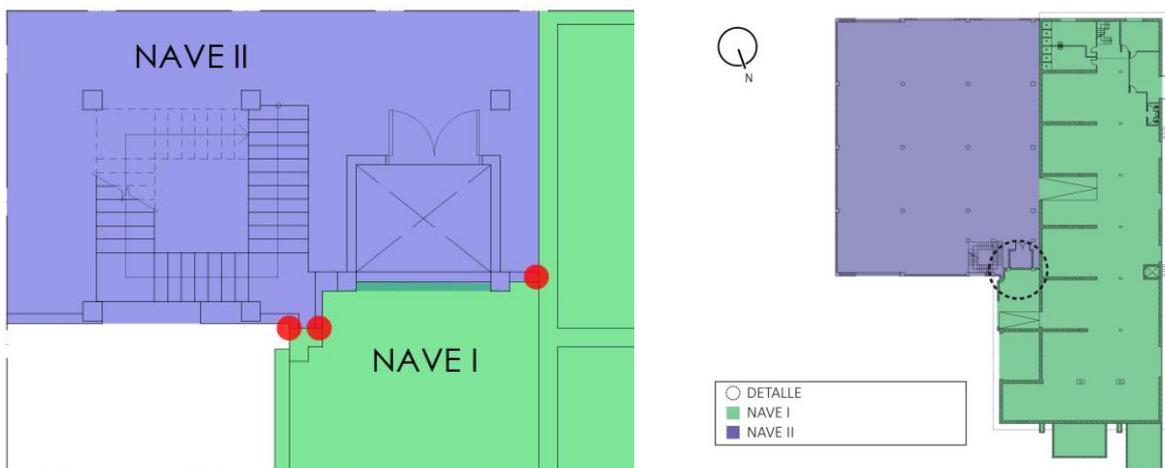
Esquema de la localización de las grietas detectadas (plano planta baja). Fuente: elaboración propia.
